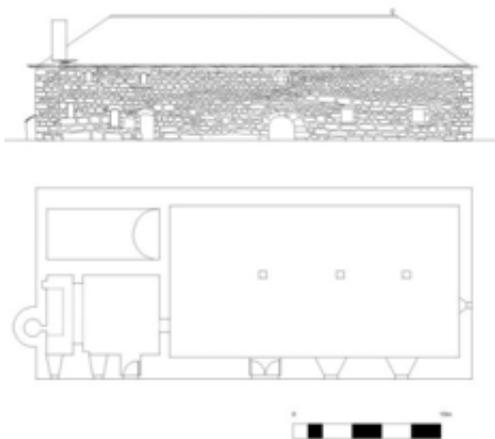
Plan et façade types de la maison-bloc, d'après les relevés de la ferme de la Besse, Usclades-et-Rieutord (07)
